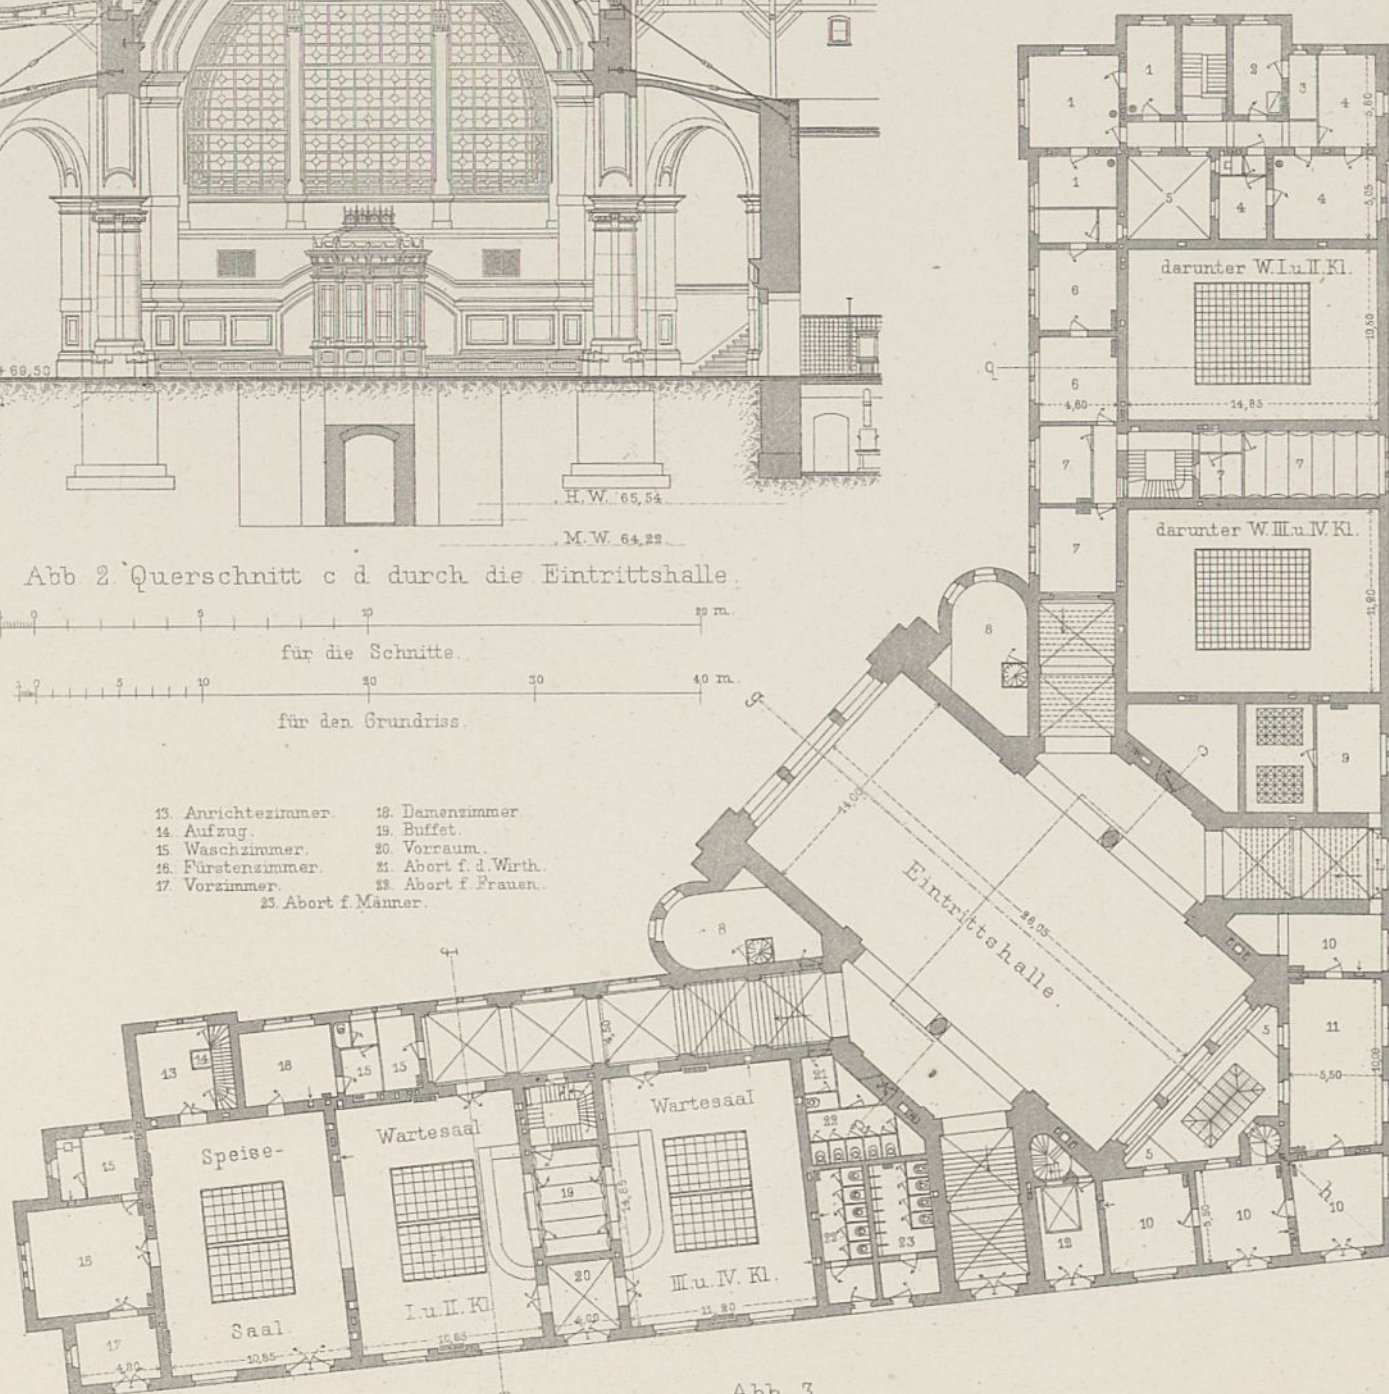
Grundriss in Höhe des Bremer Bahnsteiges.
